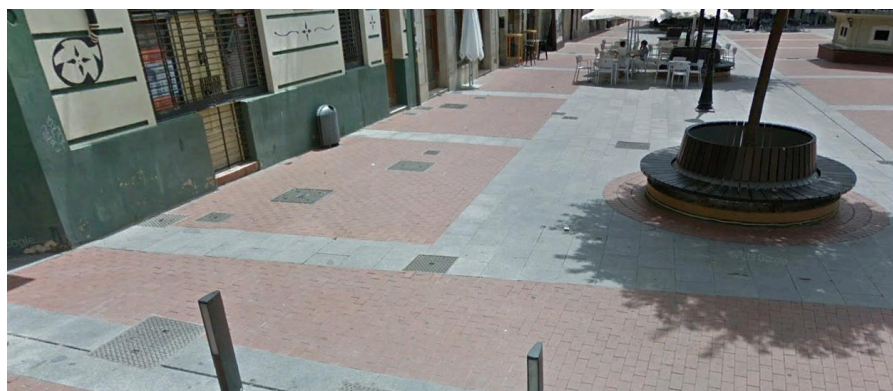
Pavimento en la margen izquierda de la Plaza de España
